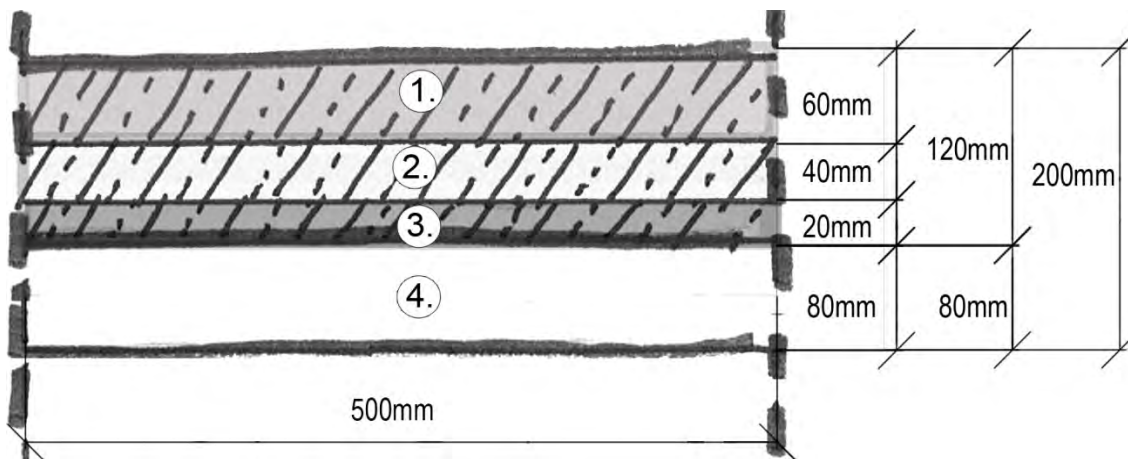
Durchschnittliche Betonmenge, = 120mm Beton Bestand, kann als Vorlage genutzt werden, Hohlraumdecke Bestand_20cm_6cm
